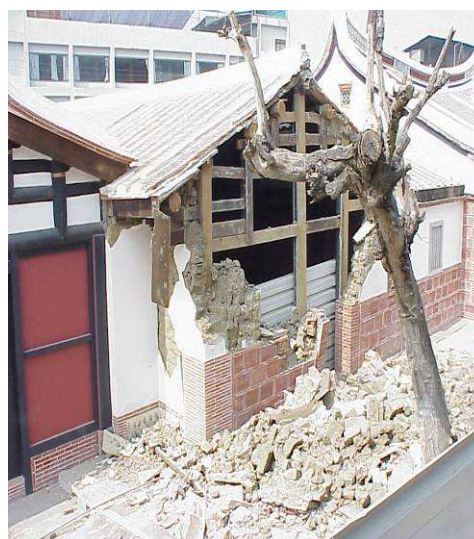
Chi-Chi 1999 – Petit temple : le parement en briques en surépaisseur a été éjecté, l'ossature en bois est restée stable.
